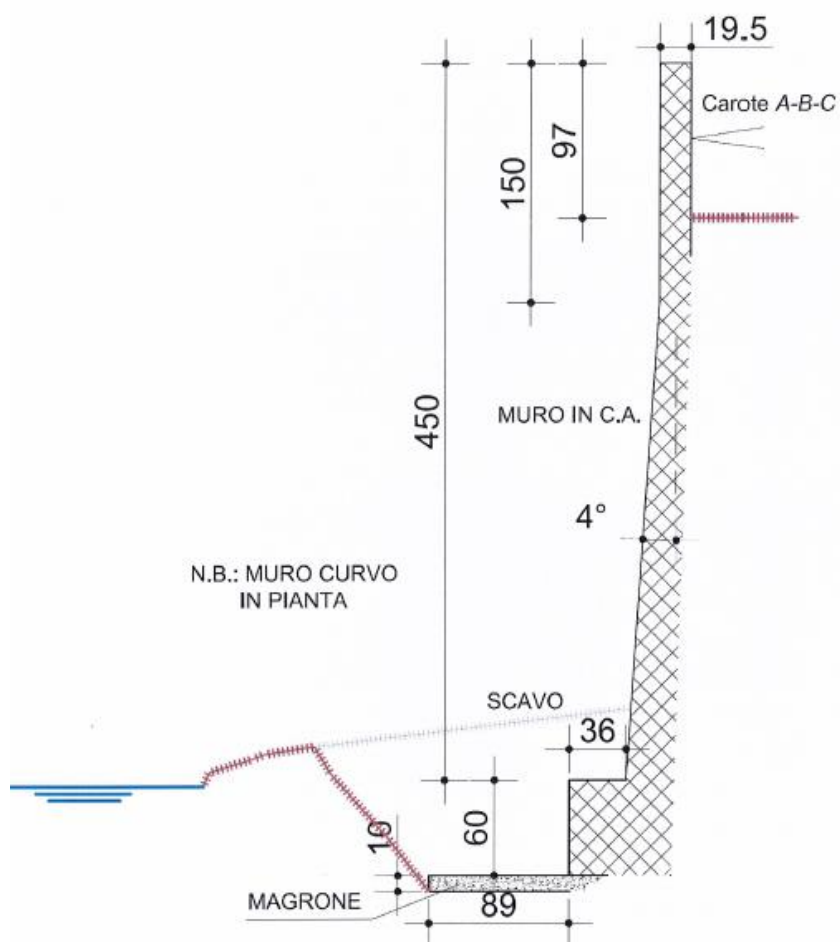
Sezione tipologica strutturale rilevata in sito
